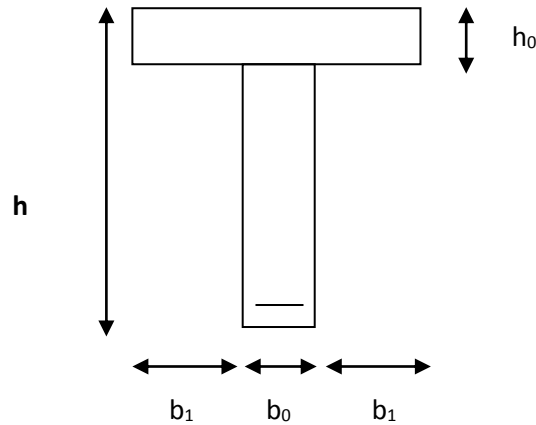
Section de calcul de la poutrelle après coulage de la dalle de compression
